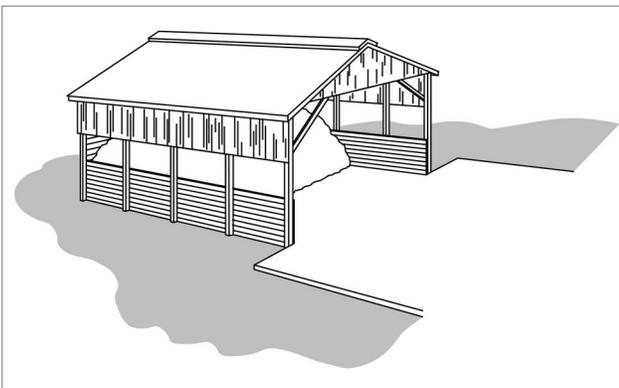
La construction de cette structure de stockage nécessite la levée d'un permis en raison de contraintes structurales spéciales.
